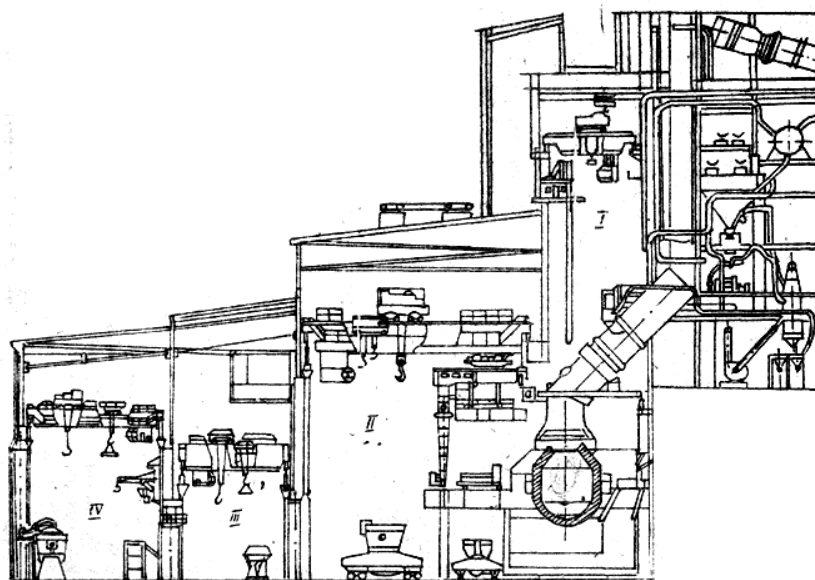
Разрез главного корпуса кислородно-конвертерного цеха
